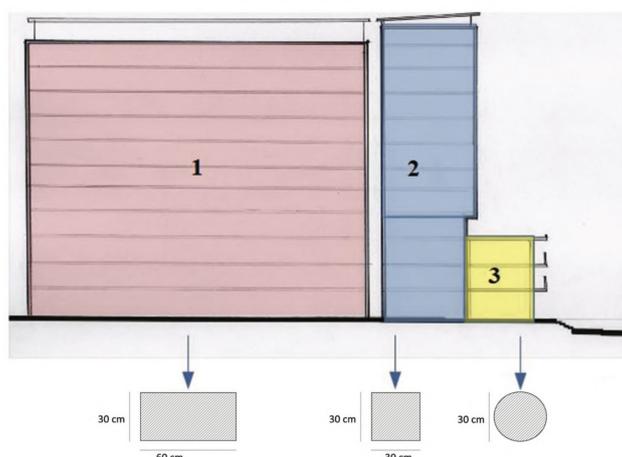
Babayan (Alex), Coupe longitudinale de la résidence d'Armenonville, dessin au feutre et crayon gris, format 21x29 cm, 20 octobre 2021, Lille
